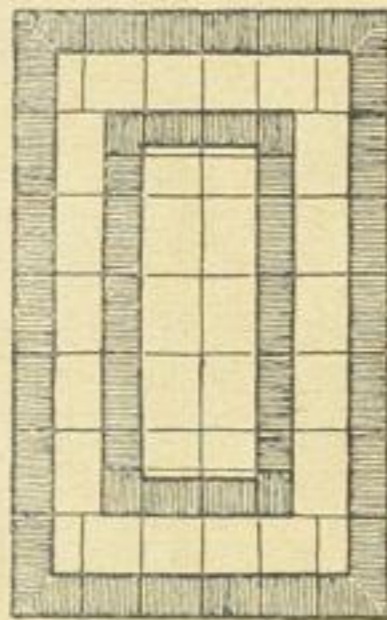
Typ eines Baublocks mit gewerblichen Betrieben.
